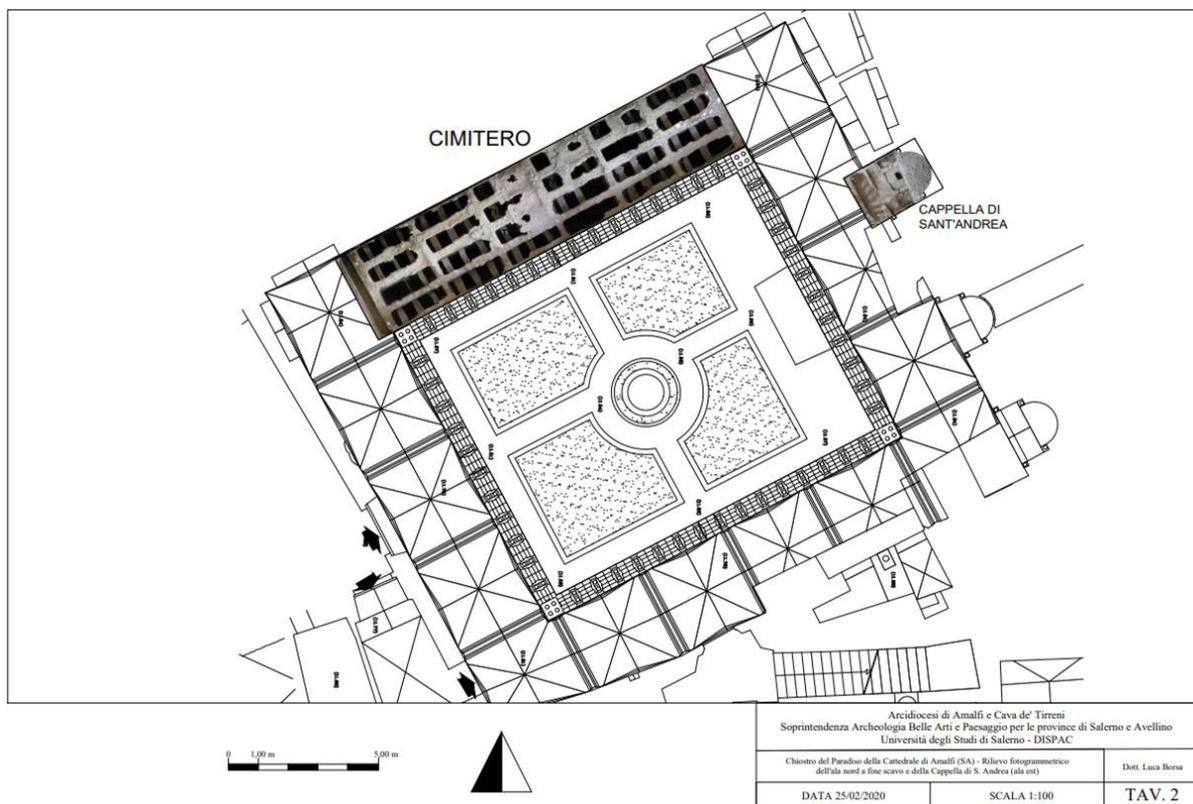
Amalfi, Chiostro del Paradiso. Rilievo planimetrico (SABAP SA – AV) con ortofoto di fine scavo (foto L. Borsa).
